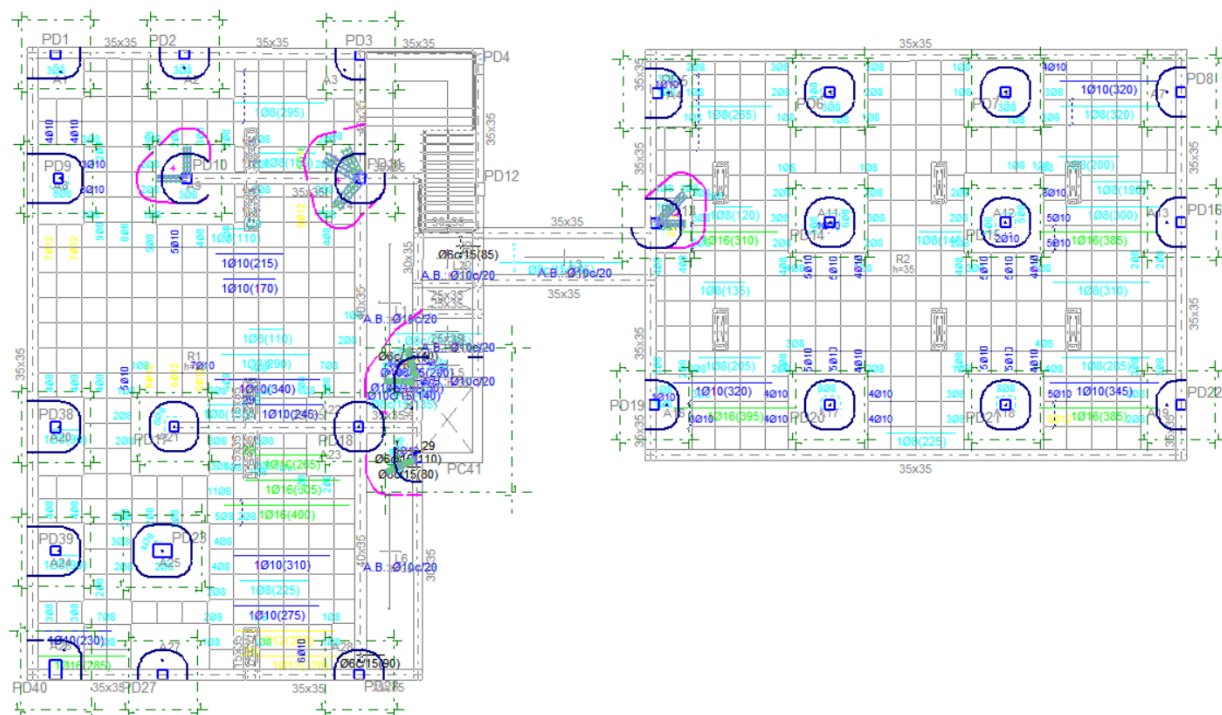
Punzonamiento Planta Tercera, Módulo D
